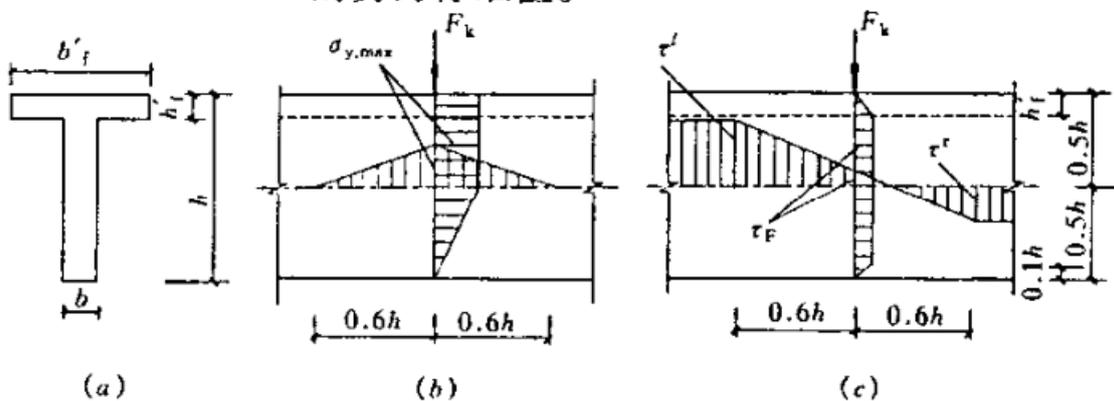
预应力混凝土吊车梁集中力作用点附近的应力分布
